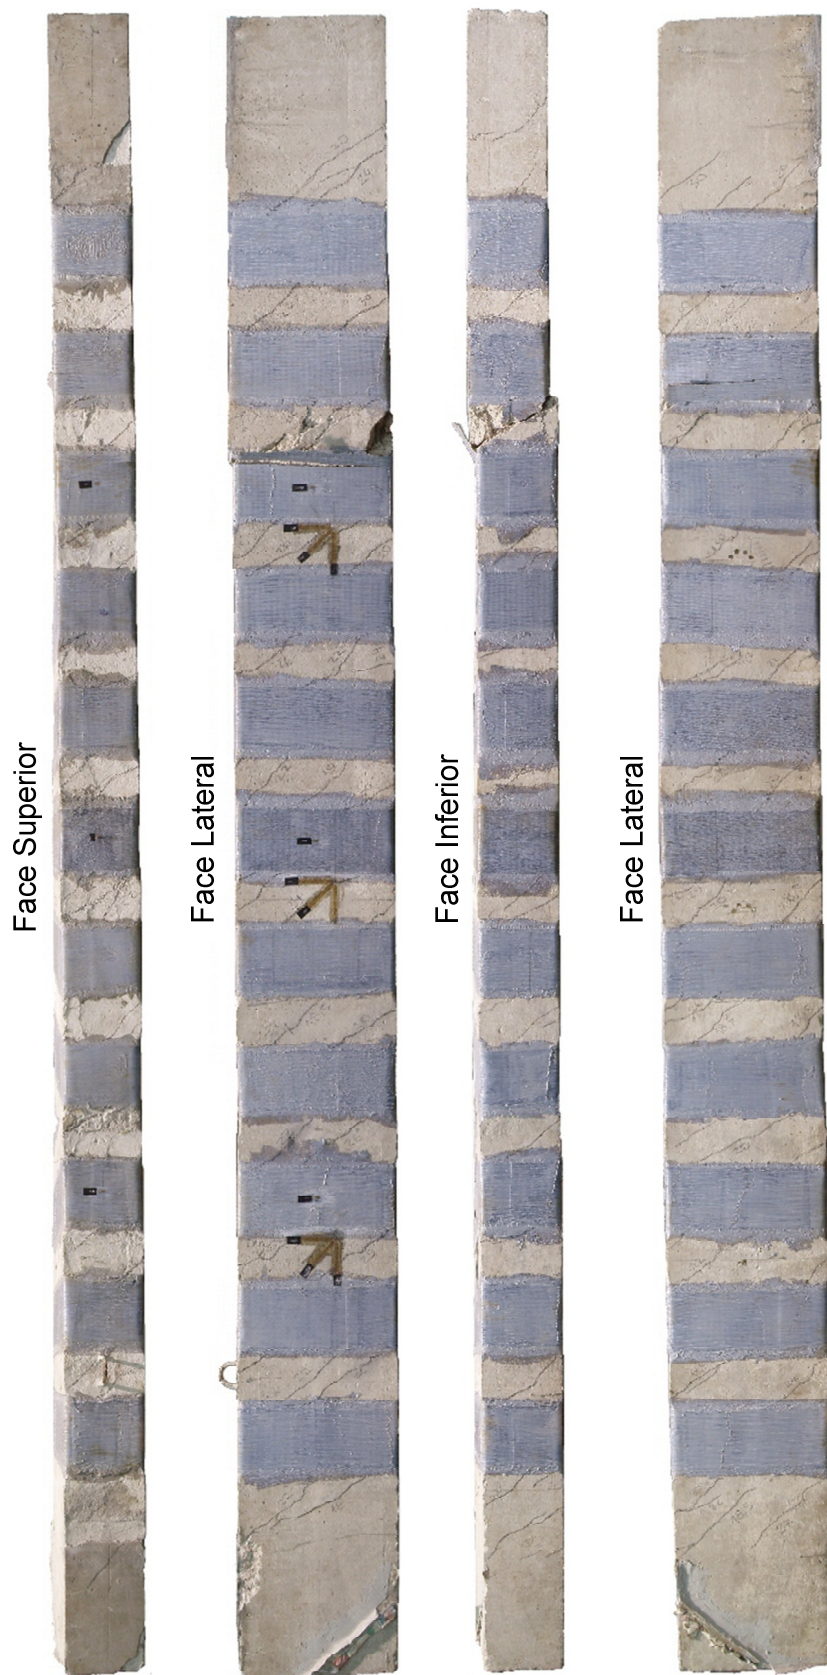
Configuração das fissuras da viga VT1.
